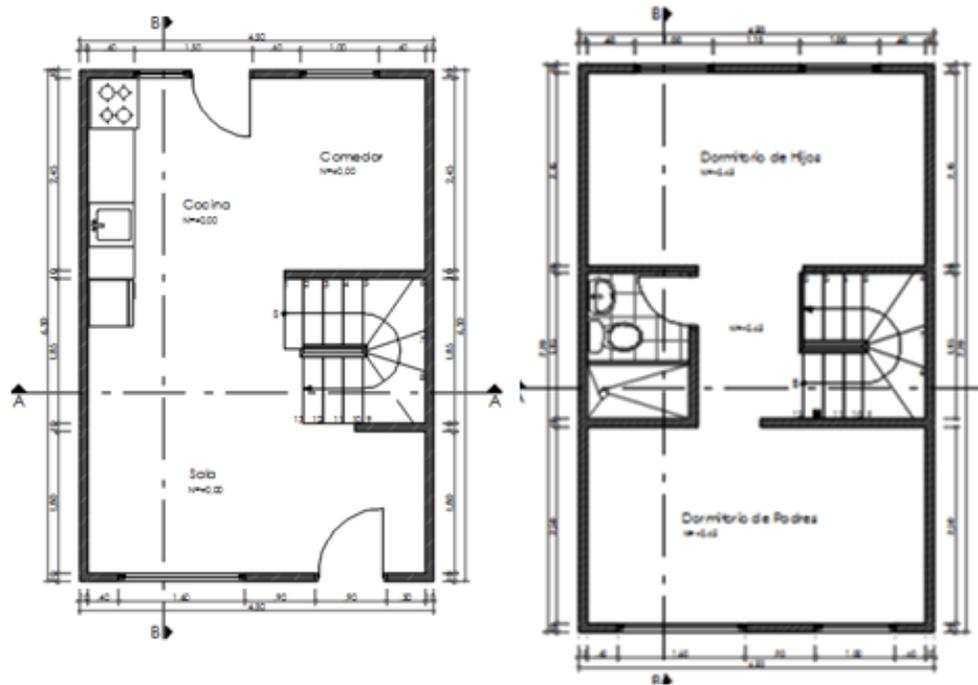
Figura 2. Planta arquitectónica de vivienda tipo en proyecto habitacional “Miraflores”
